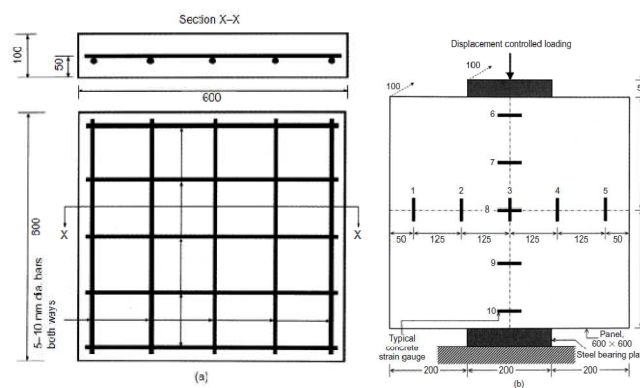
(a) Detalle de armado de los paneles ensayados (b) Disposición de las galgas para el ensayo.[13]
